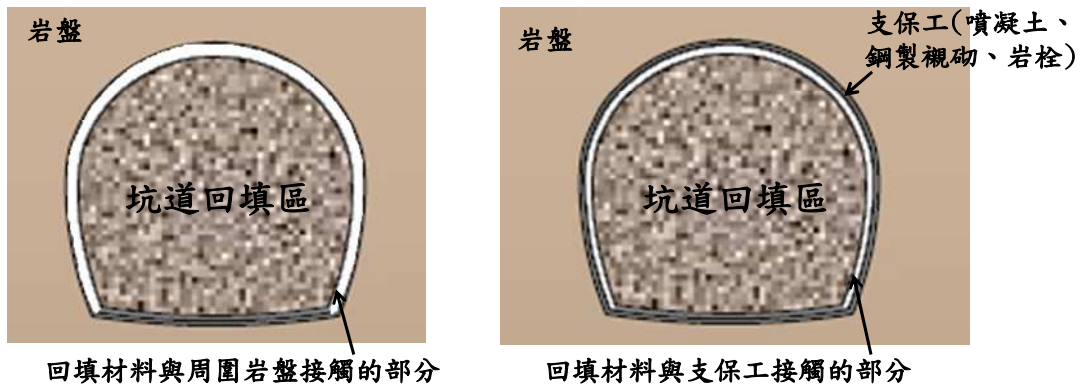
施工機械及施工方法的選擇所需留意的施工區域(回填材料)
